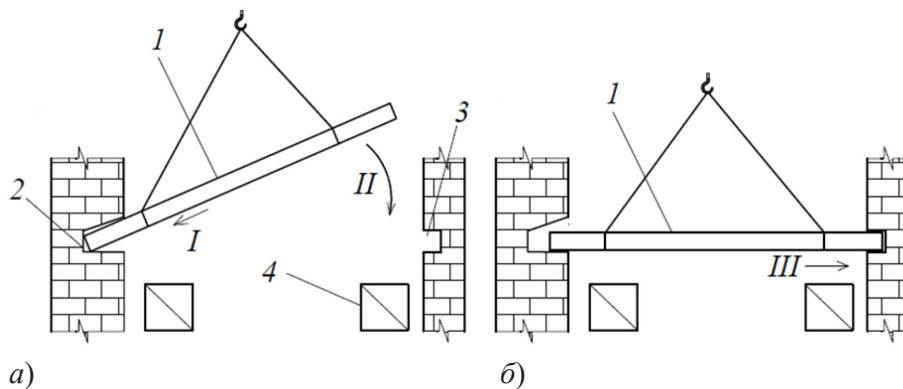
Монтаж балок перекрытия с подачей в наклонном положении:
